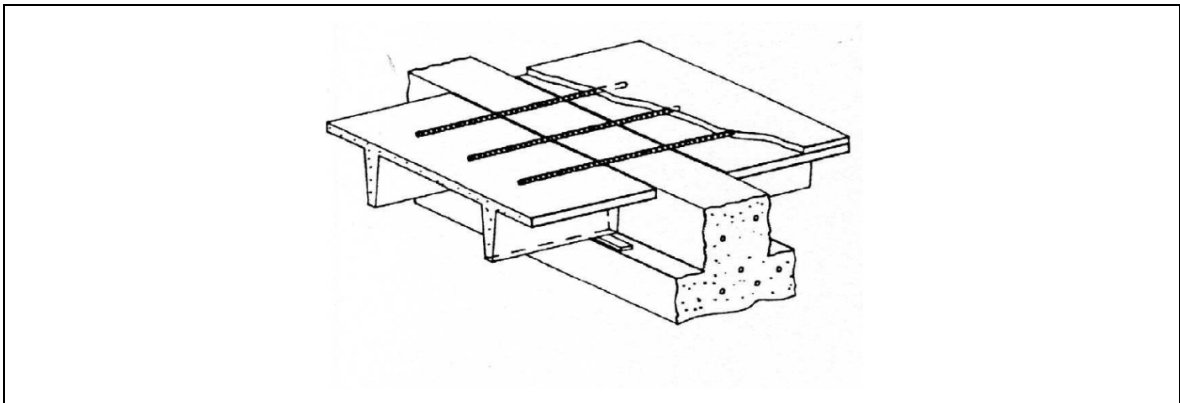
Ligação de lajes duplo “T” em vigas “T” invertido, através de armadura ordinária em lajes, assentes em neoprene , em paralelo com a laje (PCI)
